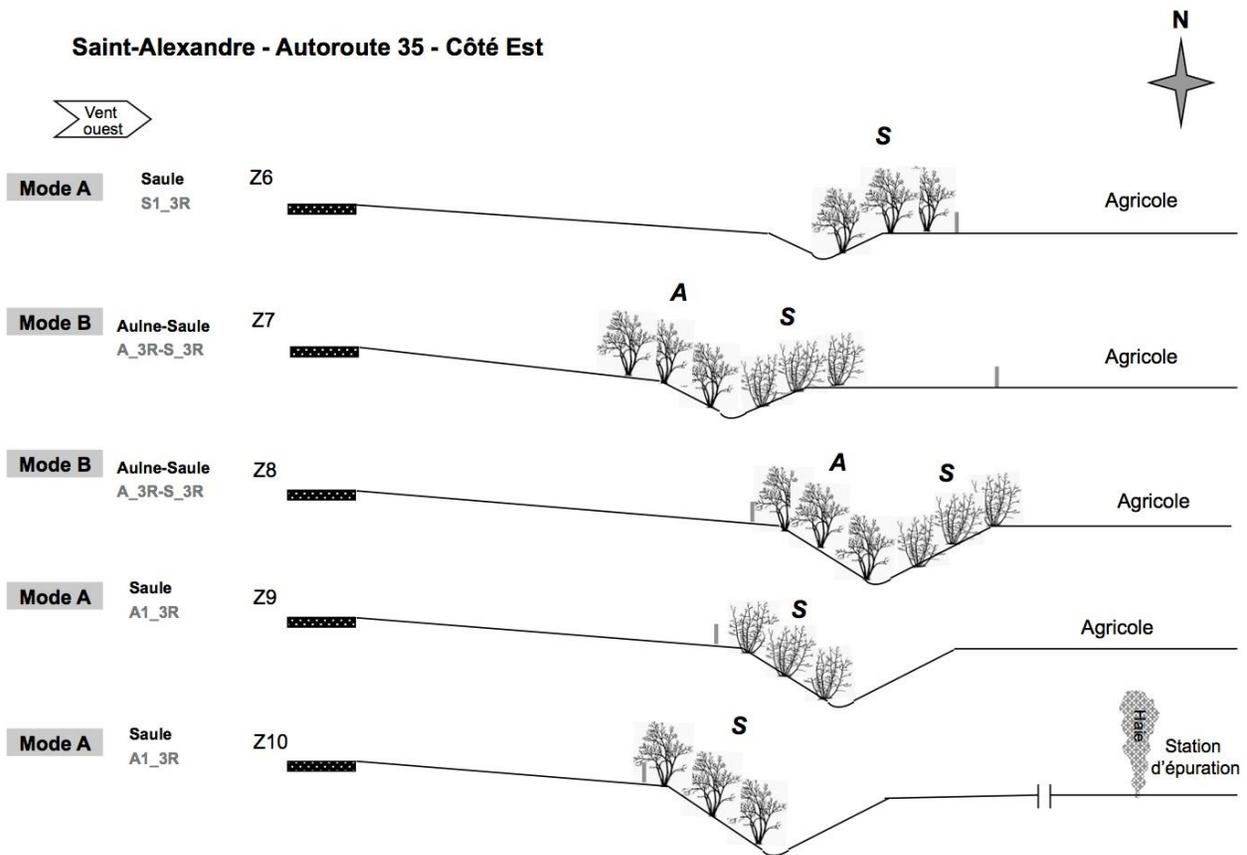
Coupe transversale des zones de plantation sur le côté Est de l'autoroute 35.
